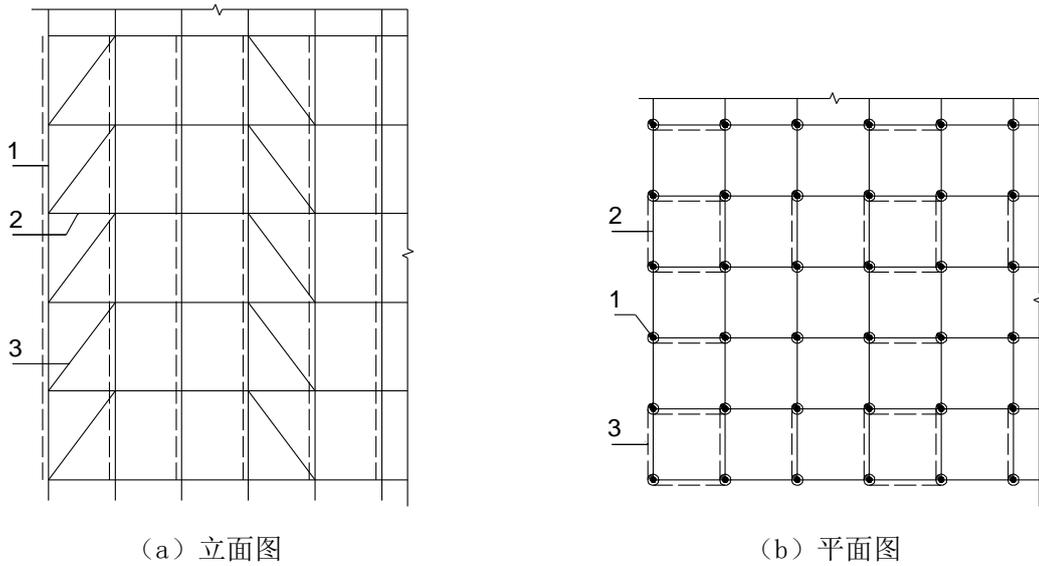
间隔 2 跨形式竖向斜杆布置示意图
